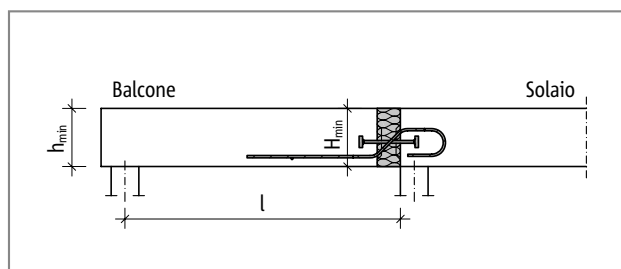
Schöck Isokorb® tipo QP20S e QP50M: schema statico
